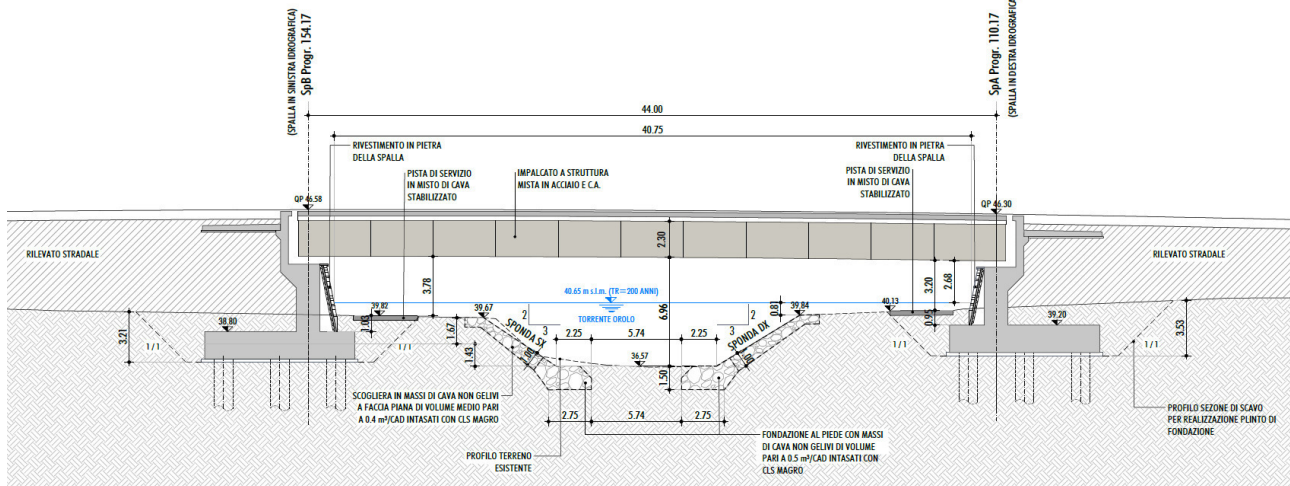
TORRENTE OROLO: SEZIONE A-A IN ASSE ALLA STRADA DI PROGETTO (VISTA DA MONTE)
